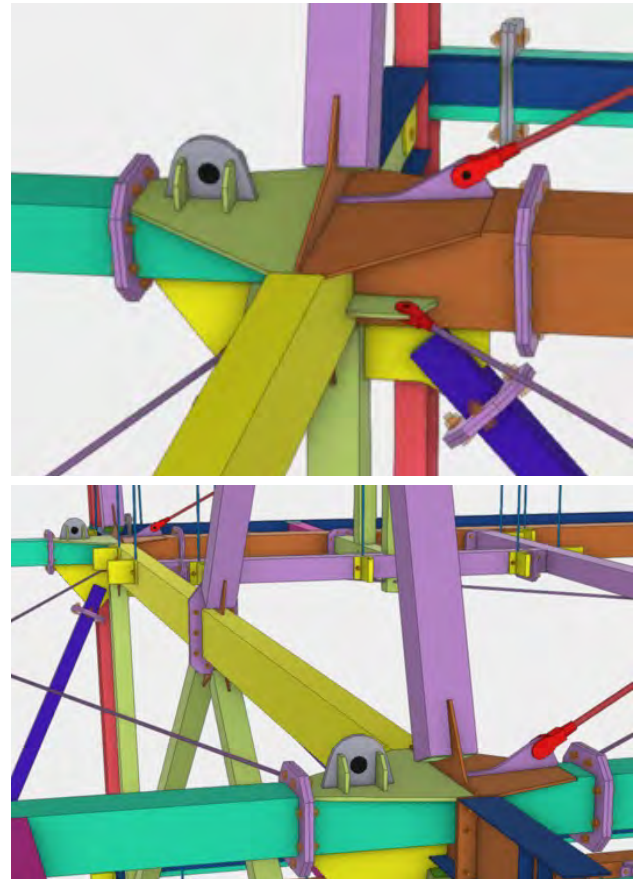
Detalle de nudo de izado en pórtico con 2 tiros. Modelo BIM de fabricación.
